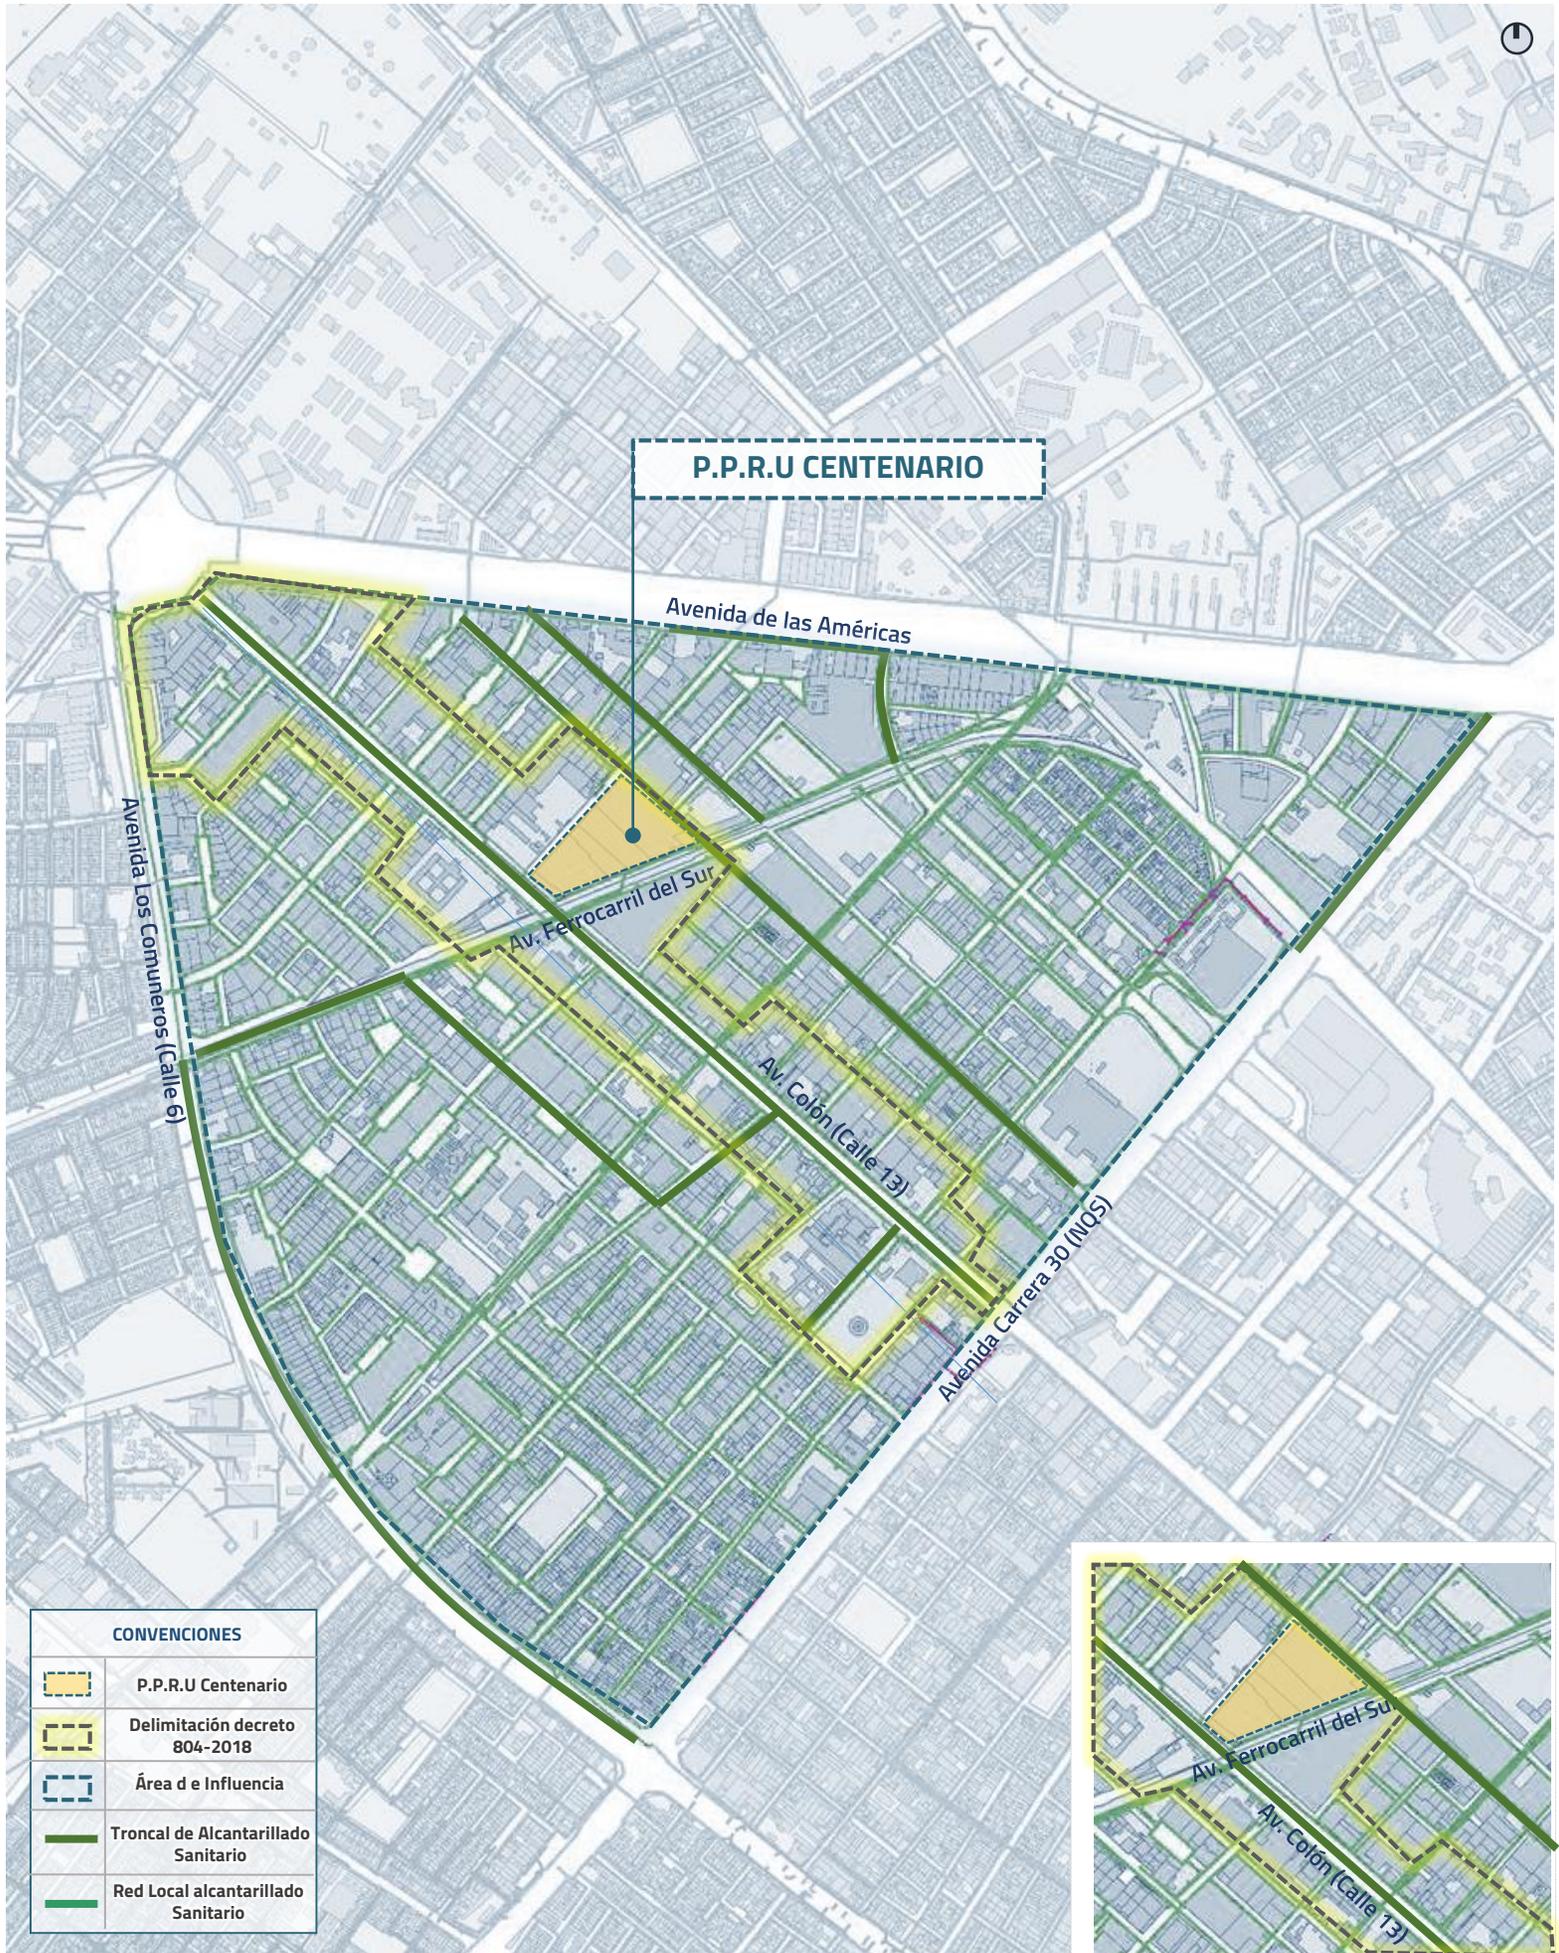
Plano de Redes de Alcantarillado Fuente: Elaboración Propia
